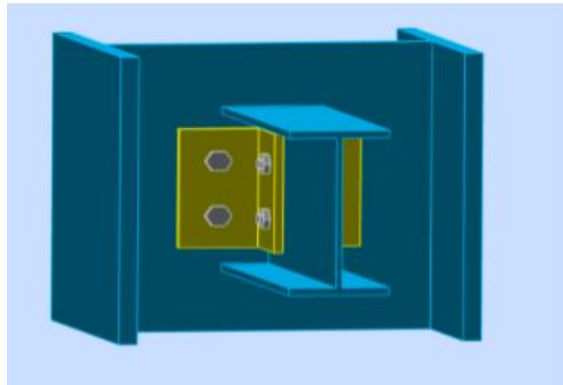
Assemblage poteau-poutre secondaire.
